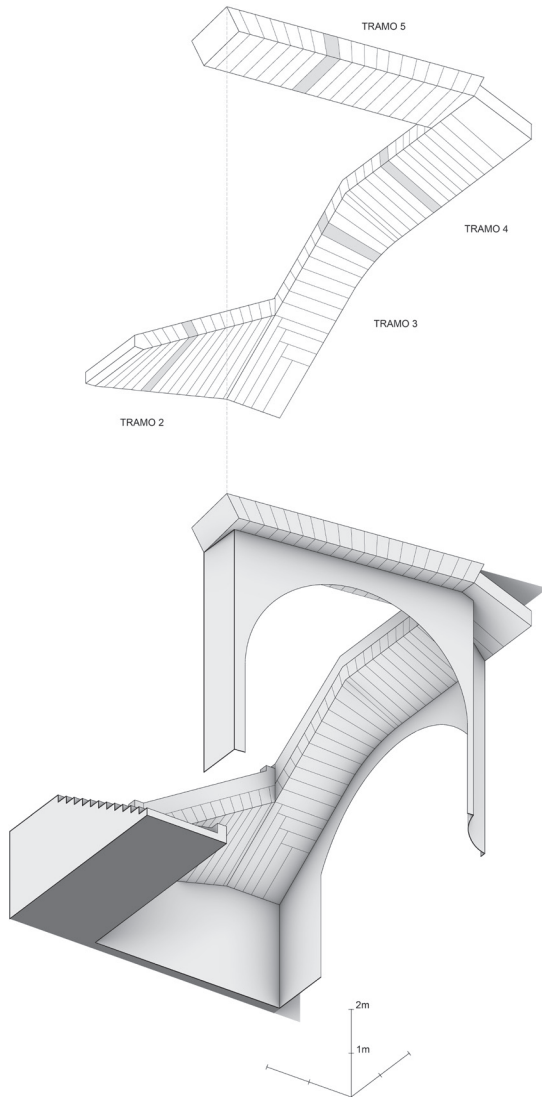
Axonometría inferior del conjunto de la escalera (imagen de los autores).
